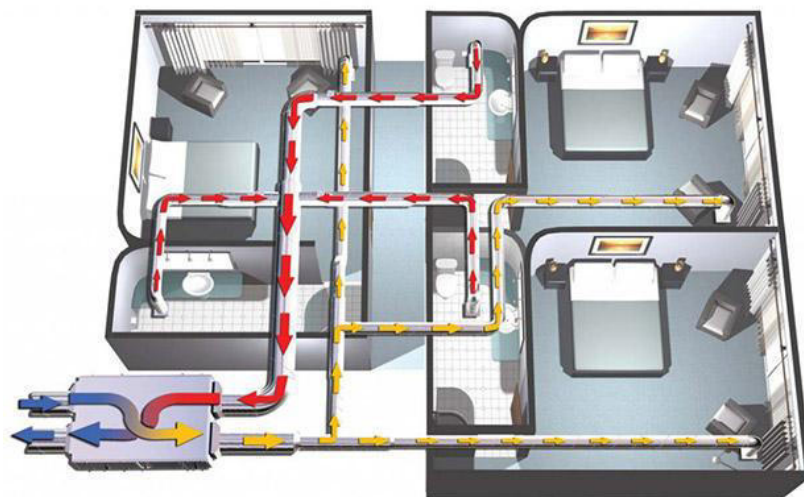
Пример приточно-вытяжной системы вентиляции жилого здания
